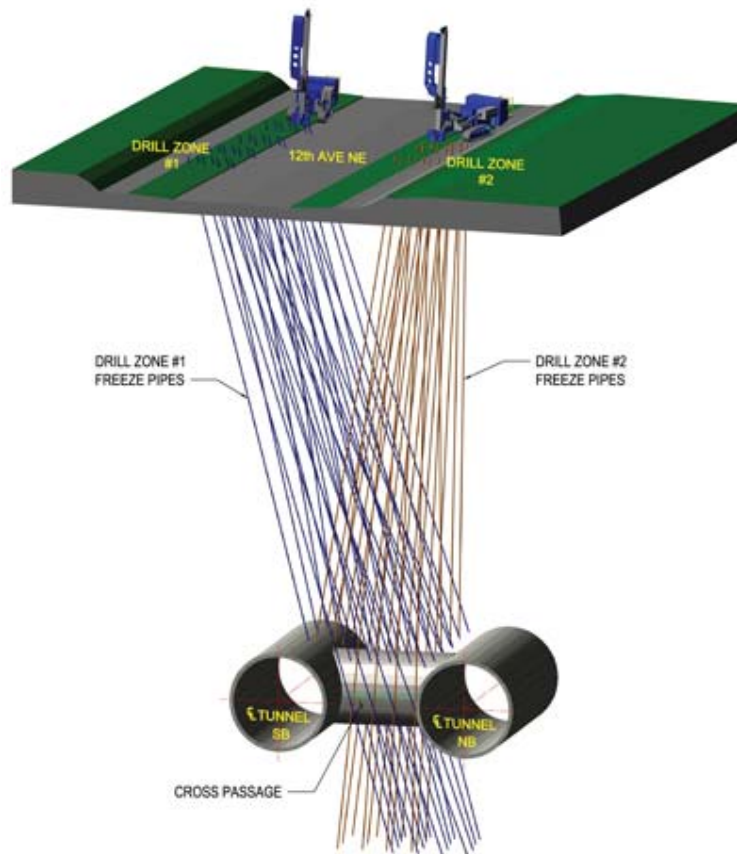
Consolidarea solului în cazul construcției unei galerii de legătură utilizând sonde verticale
